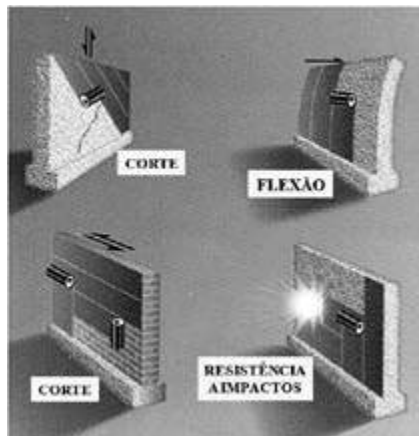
Reforço de muros, vigas-parede e alvenarias.
